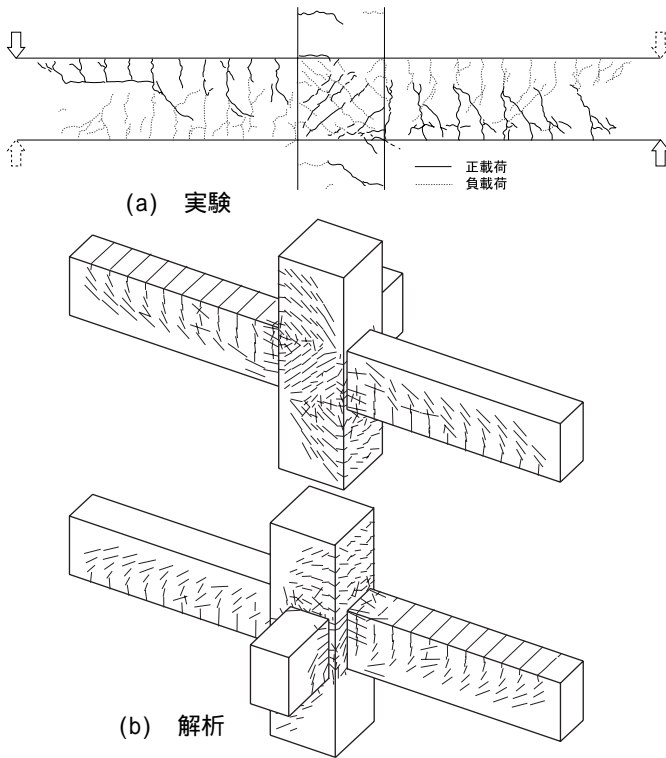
RC柱梁接合部のひび割れパターン
